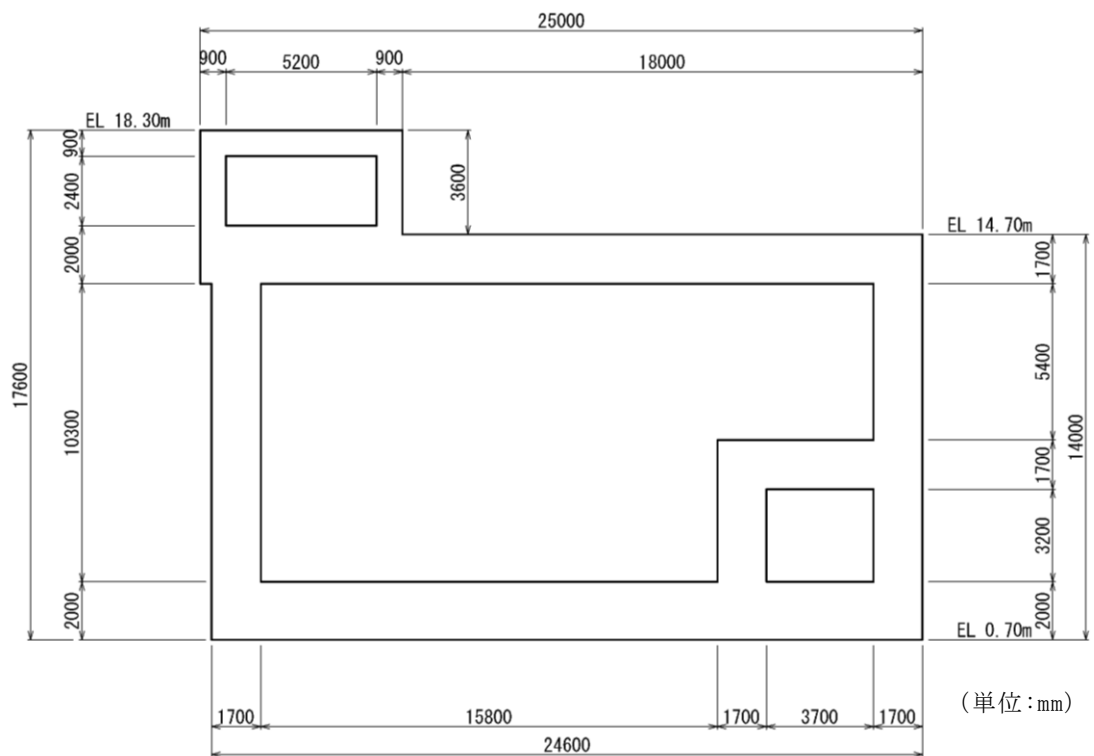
第 1 ベントフィルタ格納槽 断面図 (C-C 断面)
